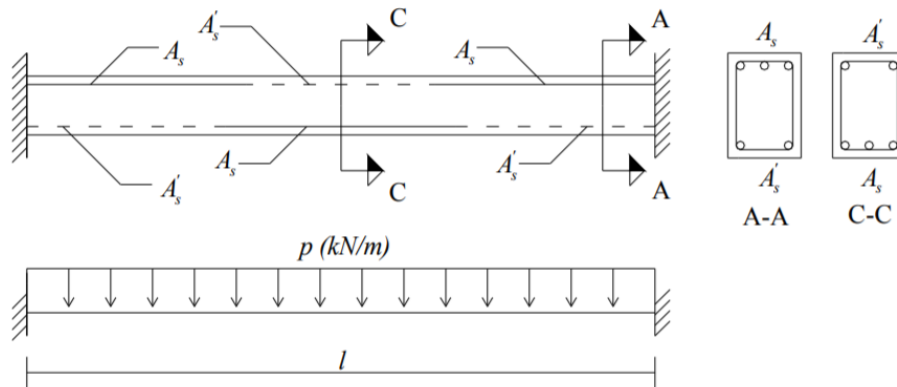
Viga biempotrada de hormigón armado bajo carga uniforme (Marí Bernat 2006).
